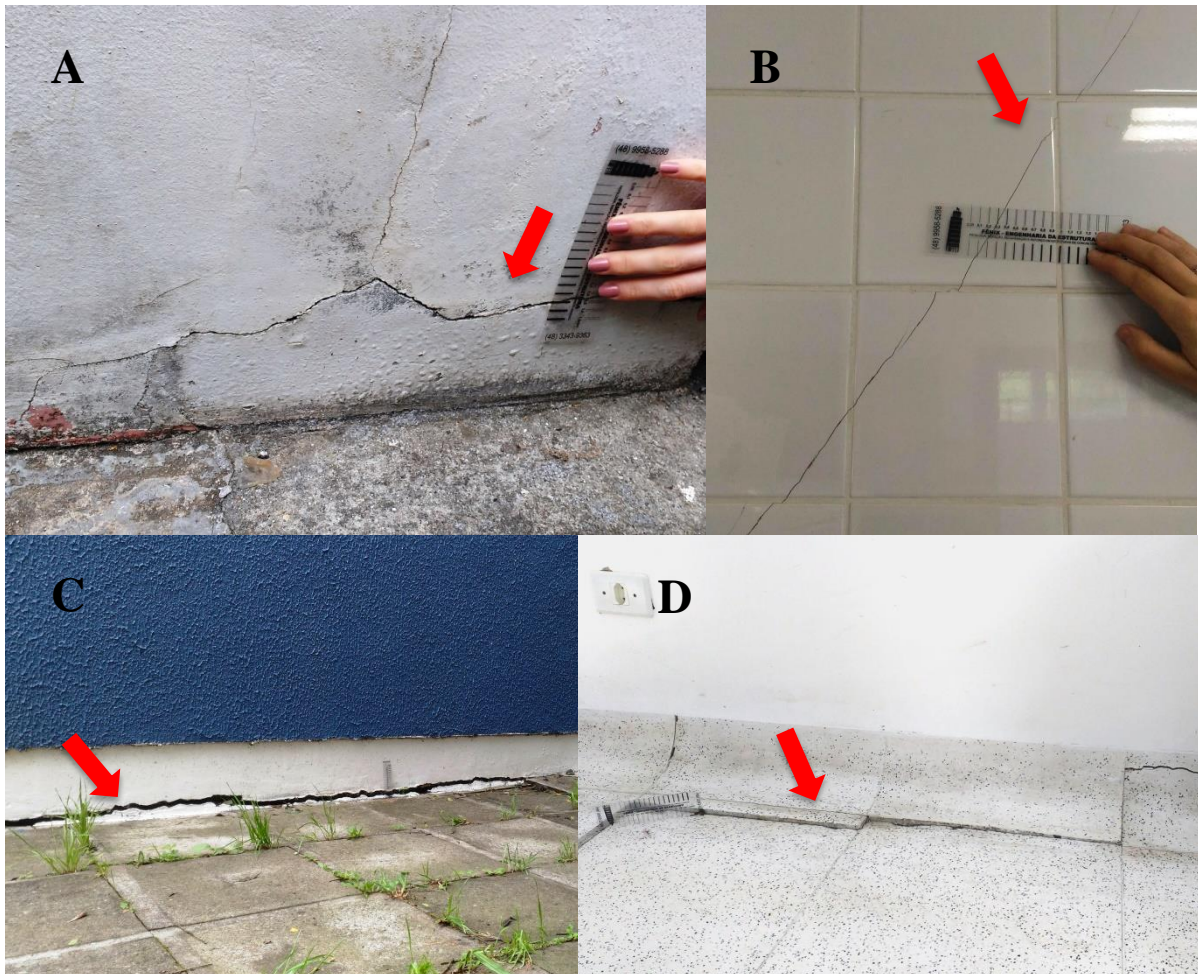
Fissuração por retração da argamassa de revestimento
